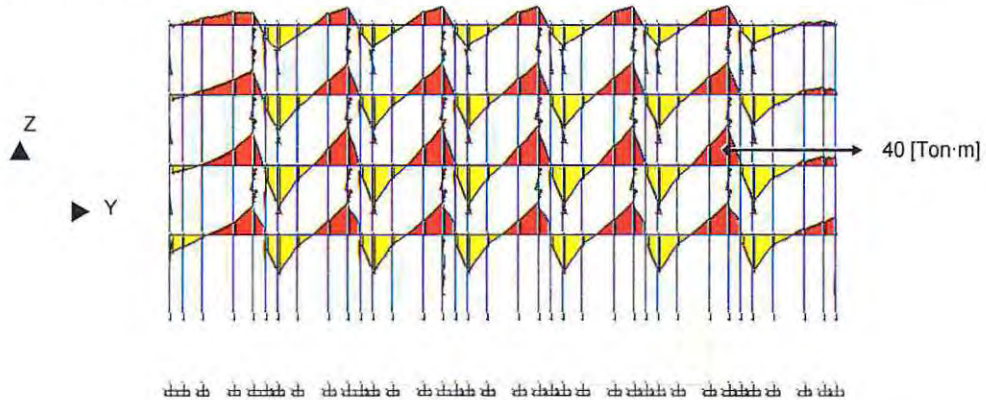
Diagrama momento en vigas de fachada, eje A, condición actual.
